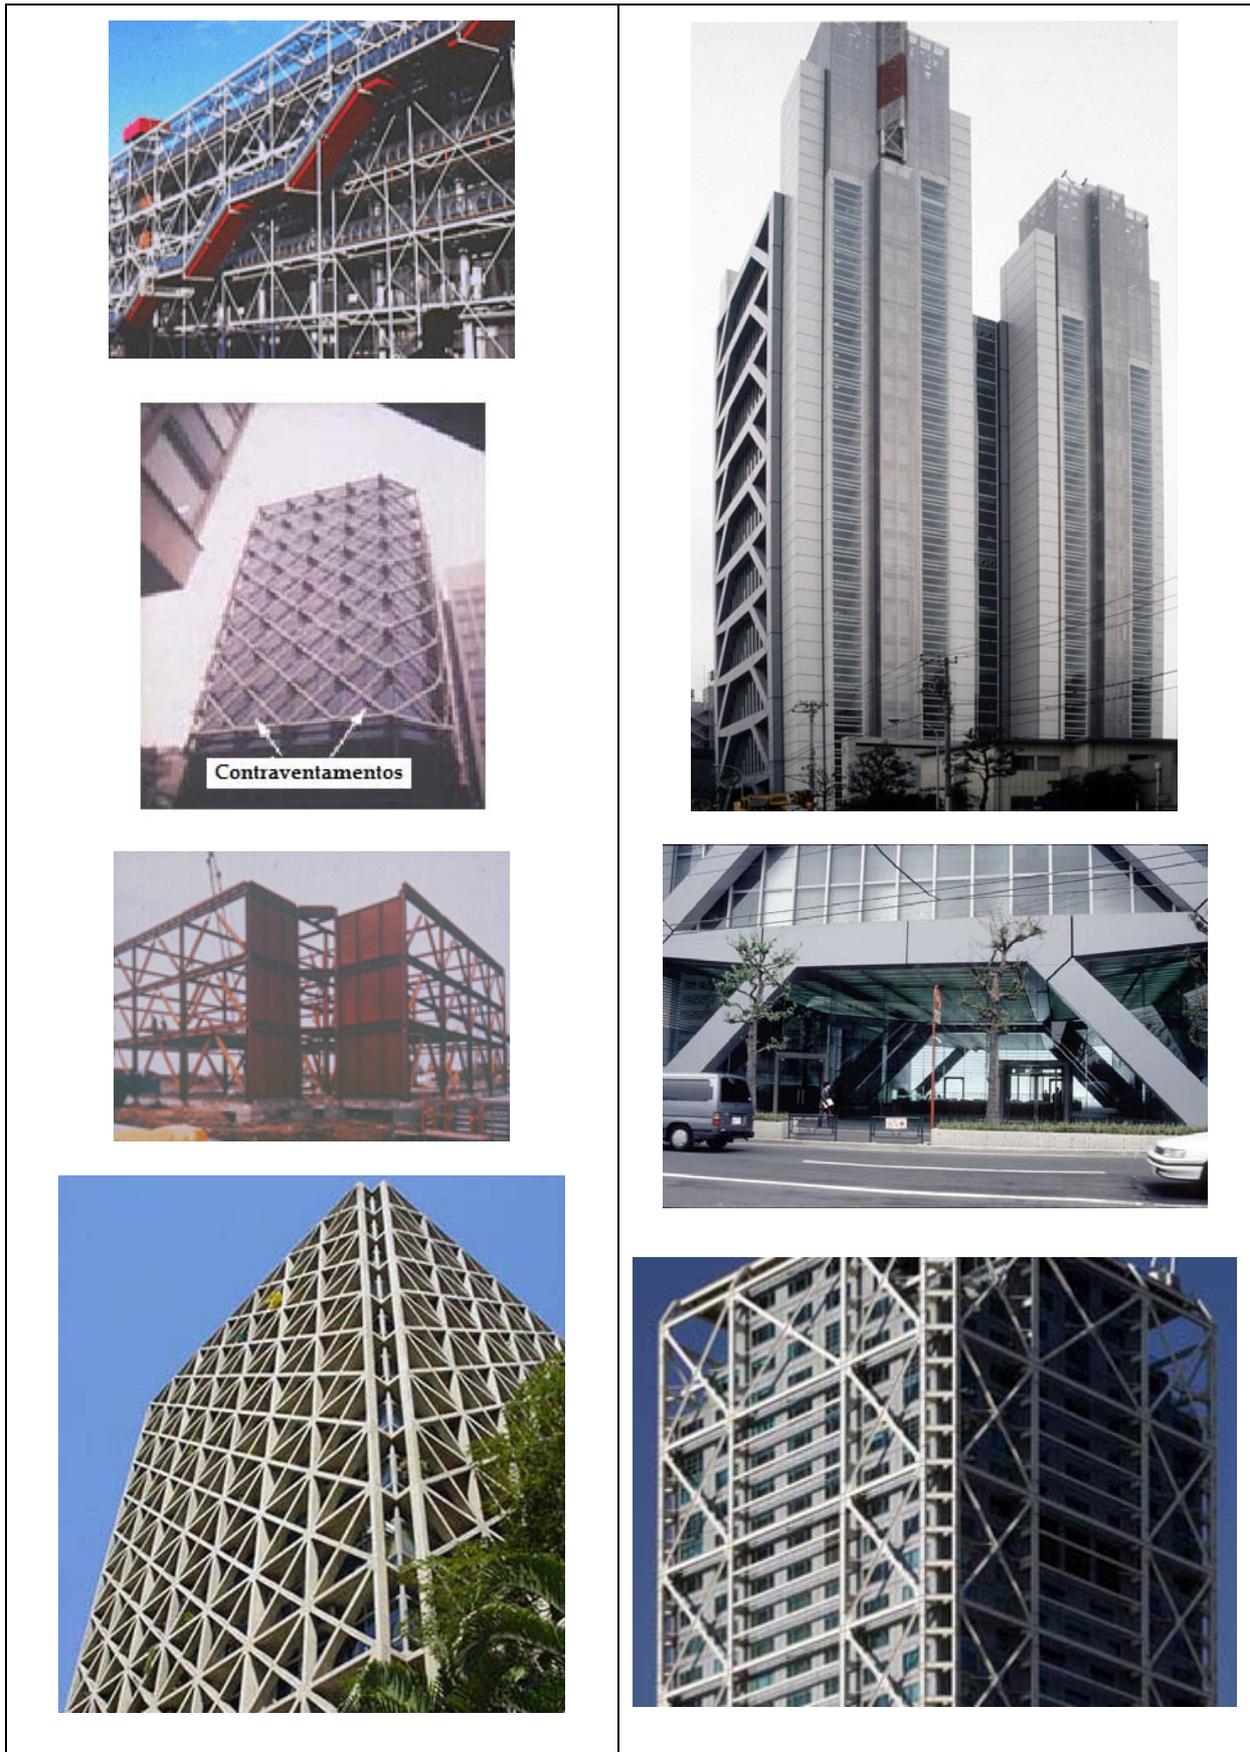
Contraventamento planos conjuntos com resultante espacial [7] e [26]
